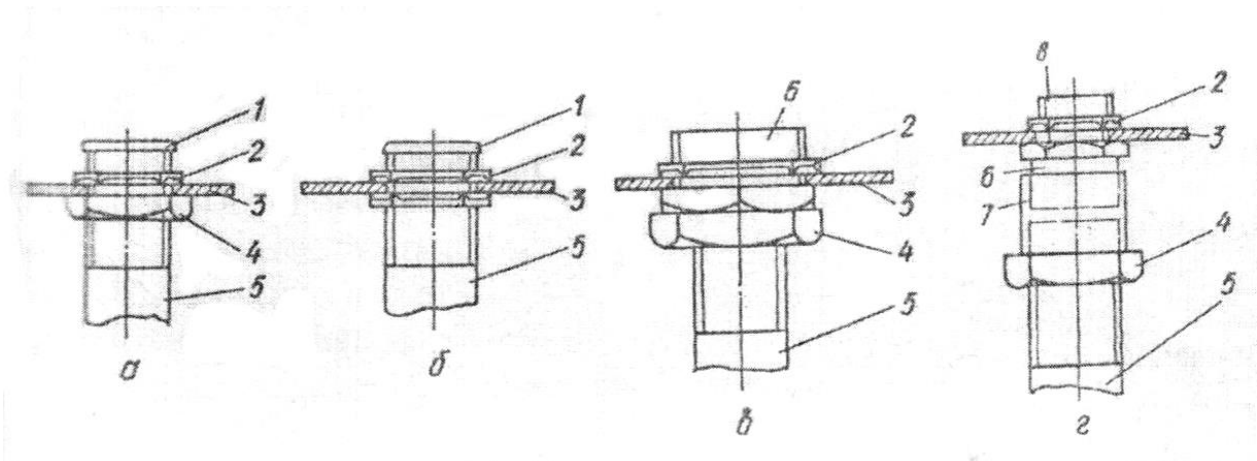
З'єднання труб електропроводки з корпусами апаратів:
